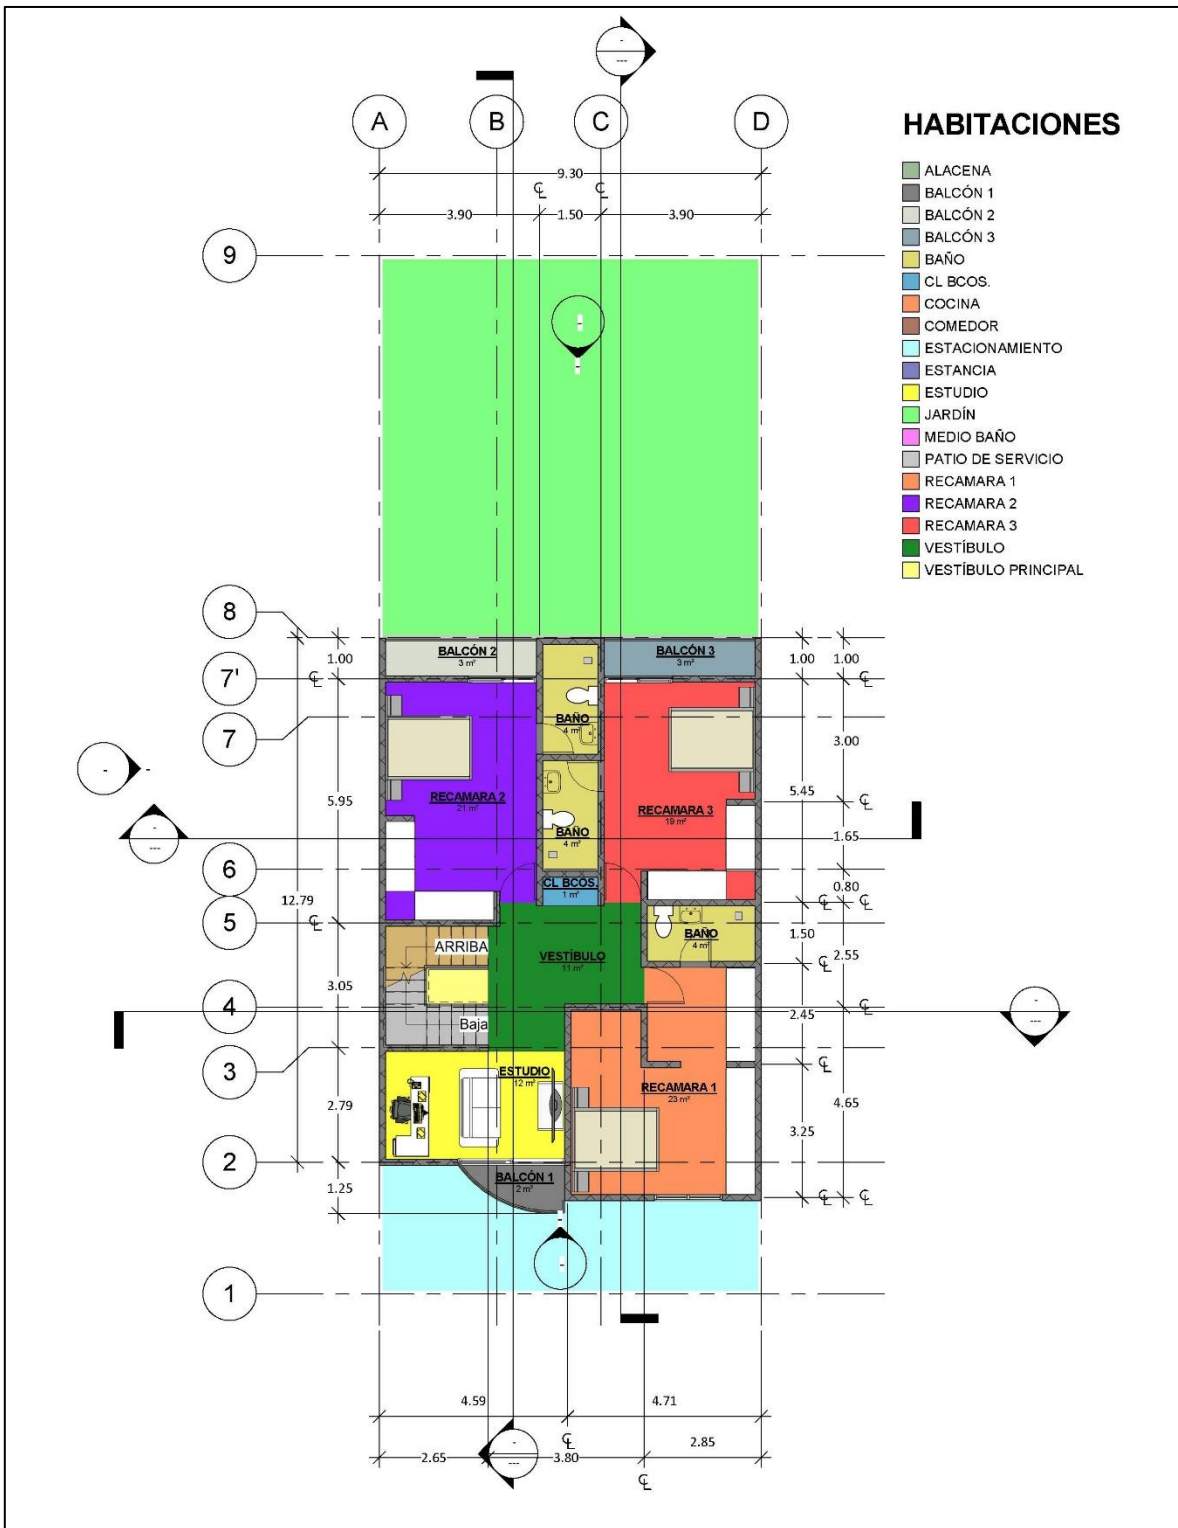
Plano de vivienda no sustentable: planta alta. Fuente: autoría propia
